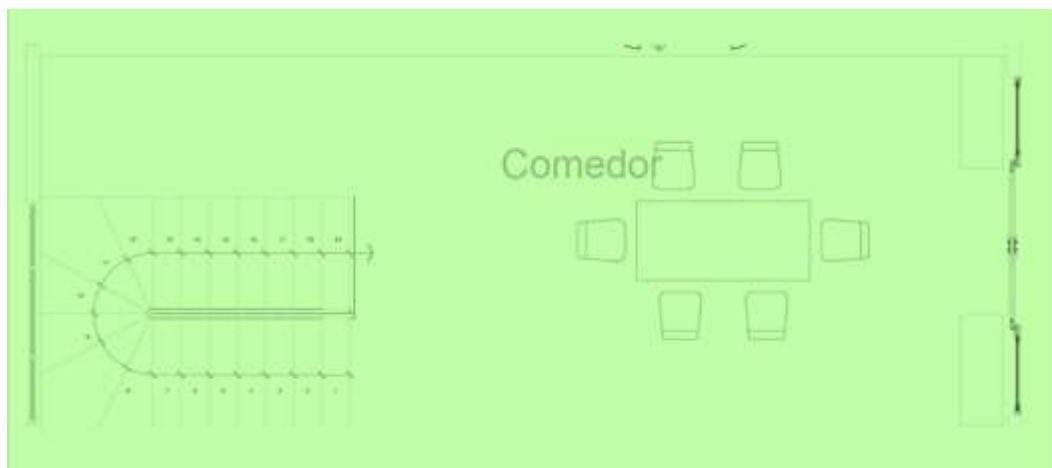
Módulo 2 Planta baja - Vivienda Bioclimática Modular sector Nobol
